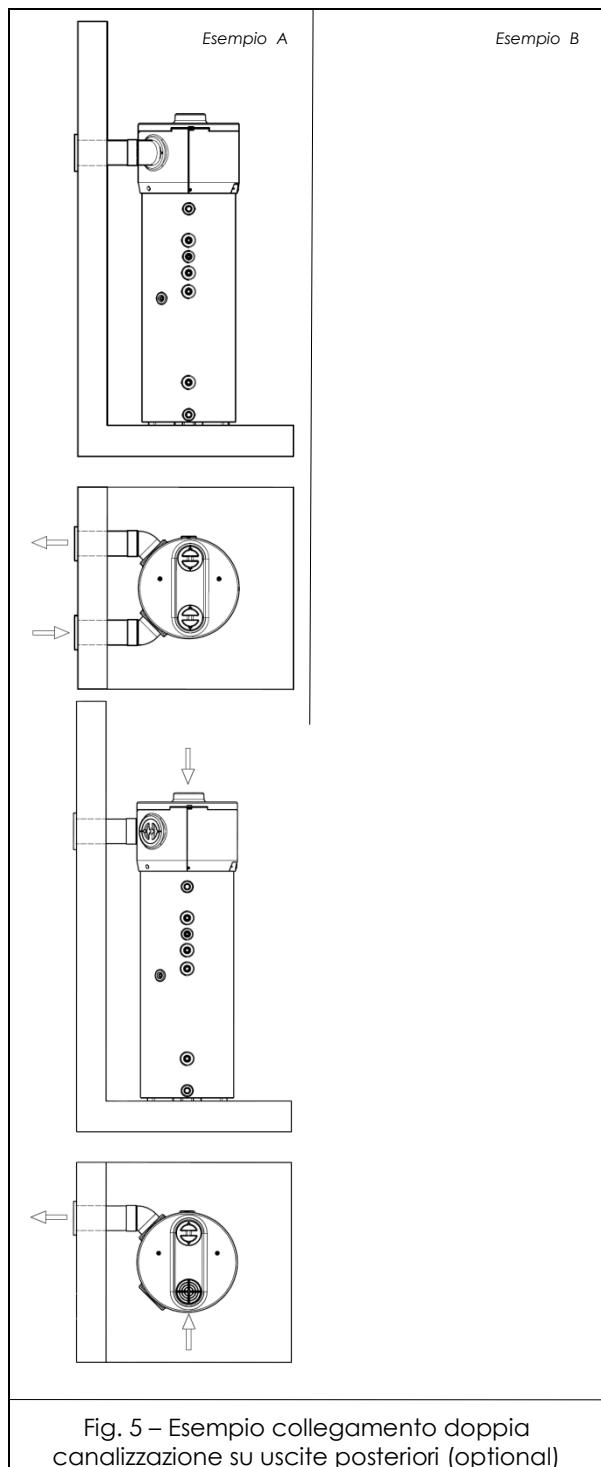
Esempio collegamento doppia canalizzazione su uscite posteriori (optional)
